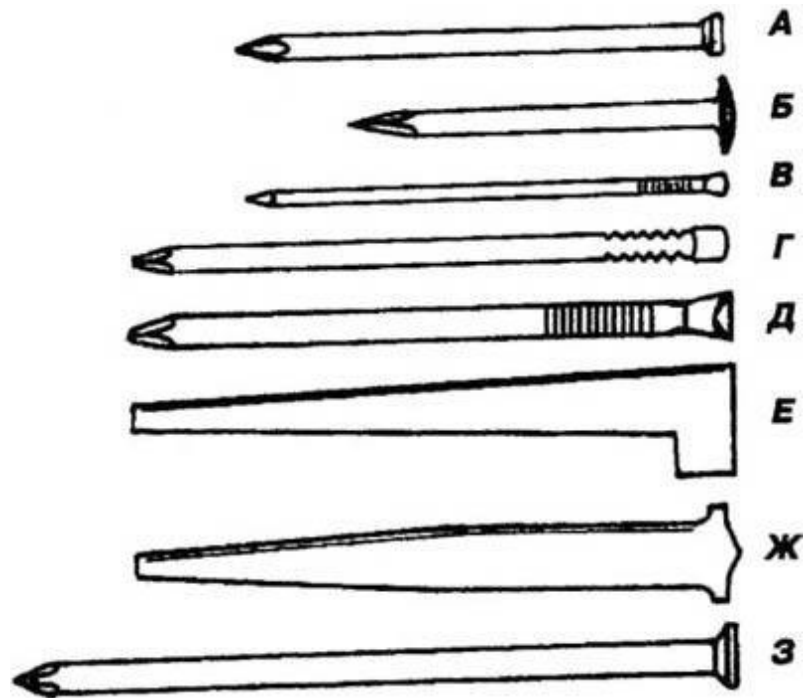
Гвозди, используемые в строительстве: А – круглый гвоздь; Б – с выпуклой шляпкой; В – напольный гвоздь; Г – овальный гвоздь; Д – гвоздь без шляпки; Е – панельный гвоздь; Ж – штукатурный гвоздь; З – настенный гвоздь
